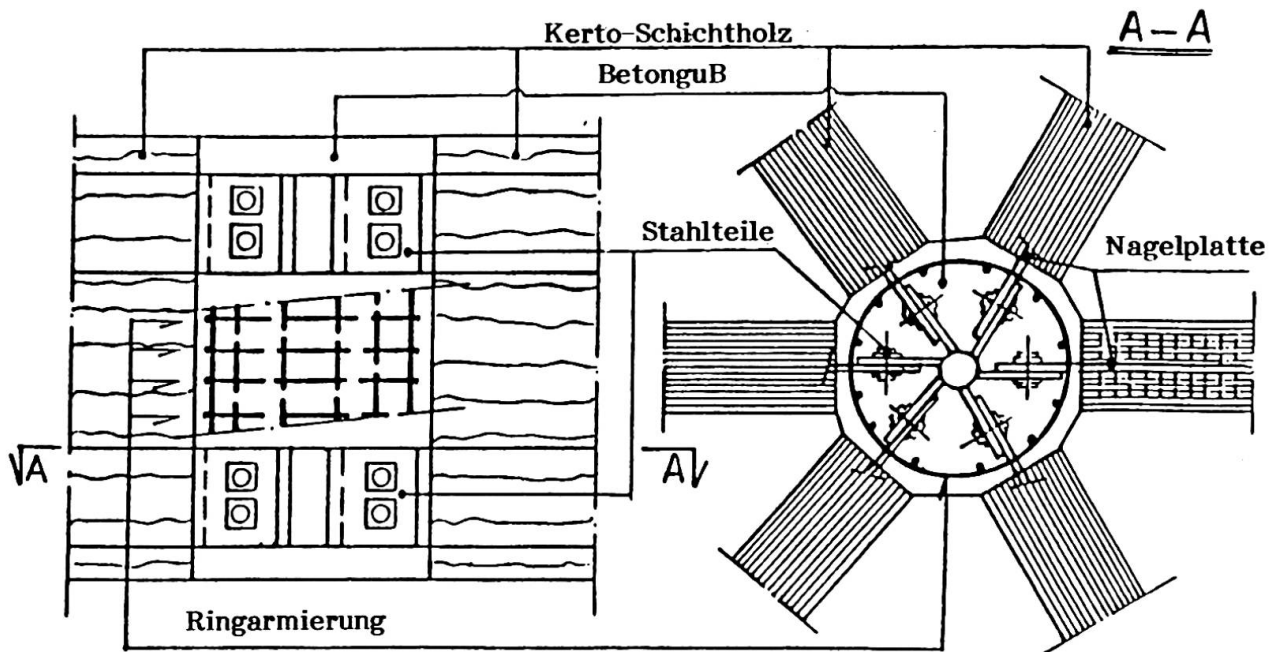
Quer- und Längsschnitt durch ein Betoniliitos.
